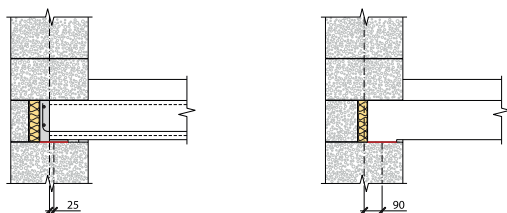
Варианты перекрытий по стенам из блоков AEROC
